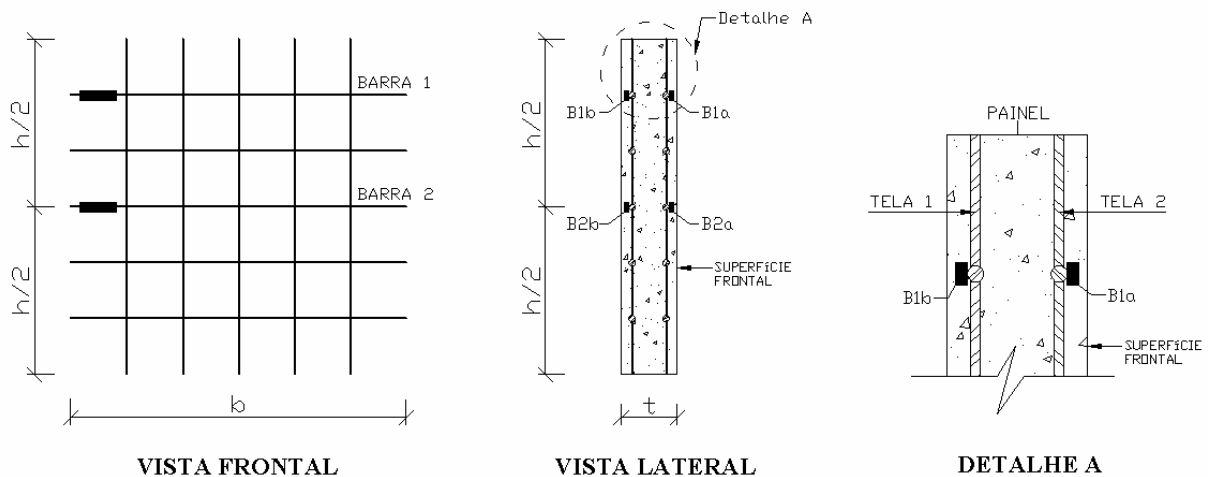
Disposição dos extensômetros na tela soldada Q196
